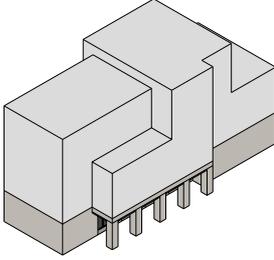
نماذج لتطبيق الطابع المعماري المحلي بنمط معاصر
